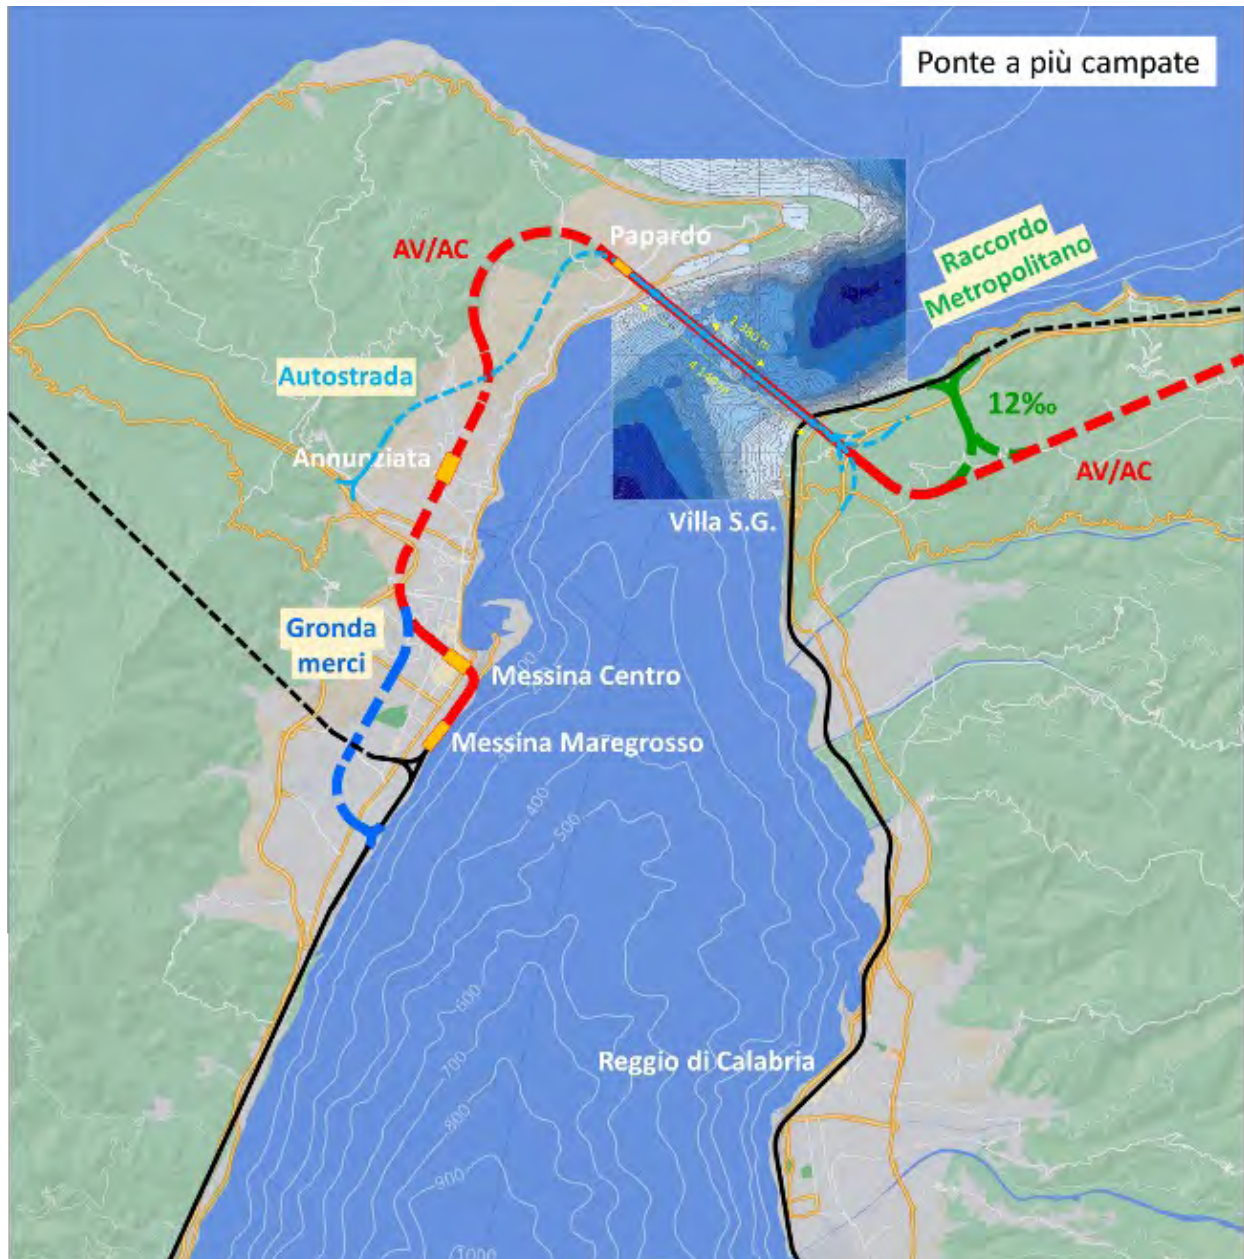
Ponte a più campate – Tracciati ferroviari- Planimetria
